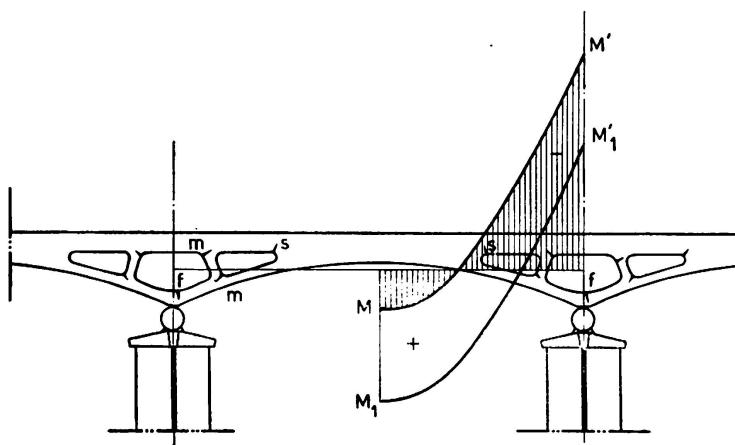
Esquema duma viga contínua de rótula. Diagramas dos momentos flectores e fissuras
